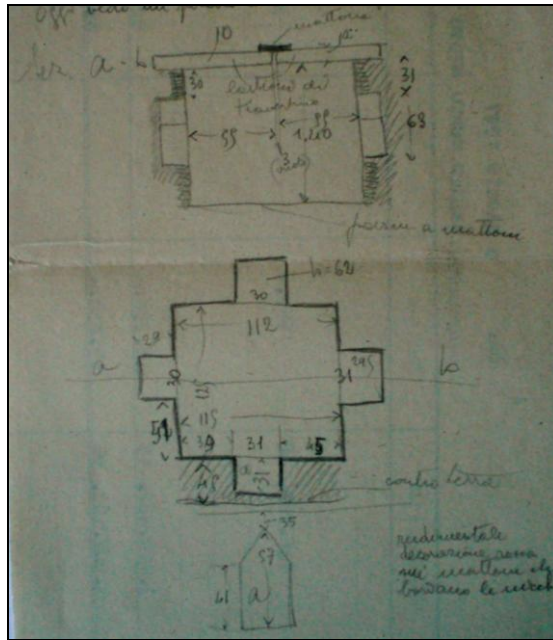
Particolare di uno schizzo planimetrico del mausoleo recuperato nel 1947 (ACS, Archivio Gatti).
